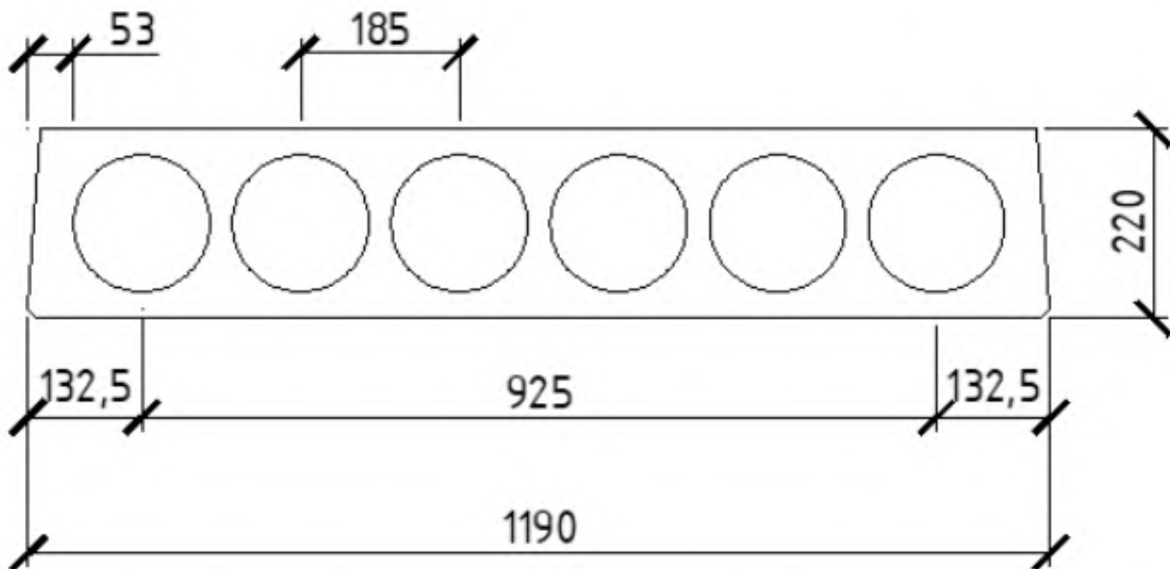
Переріз круглопустотної залізобетонної плити, шириною 1200 мм.
